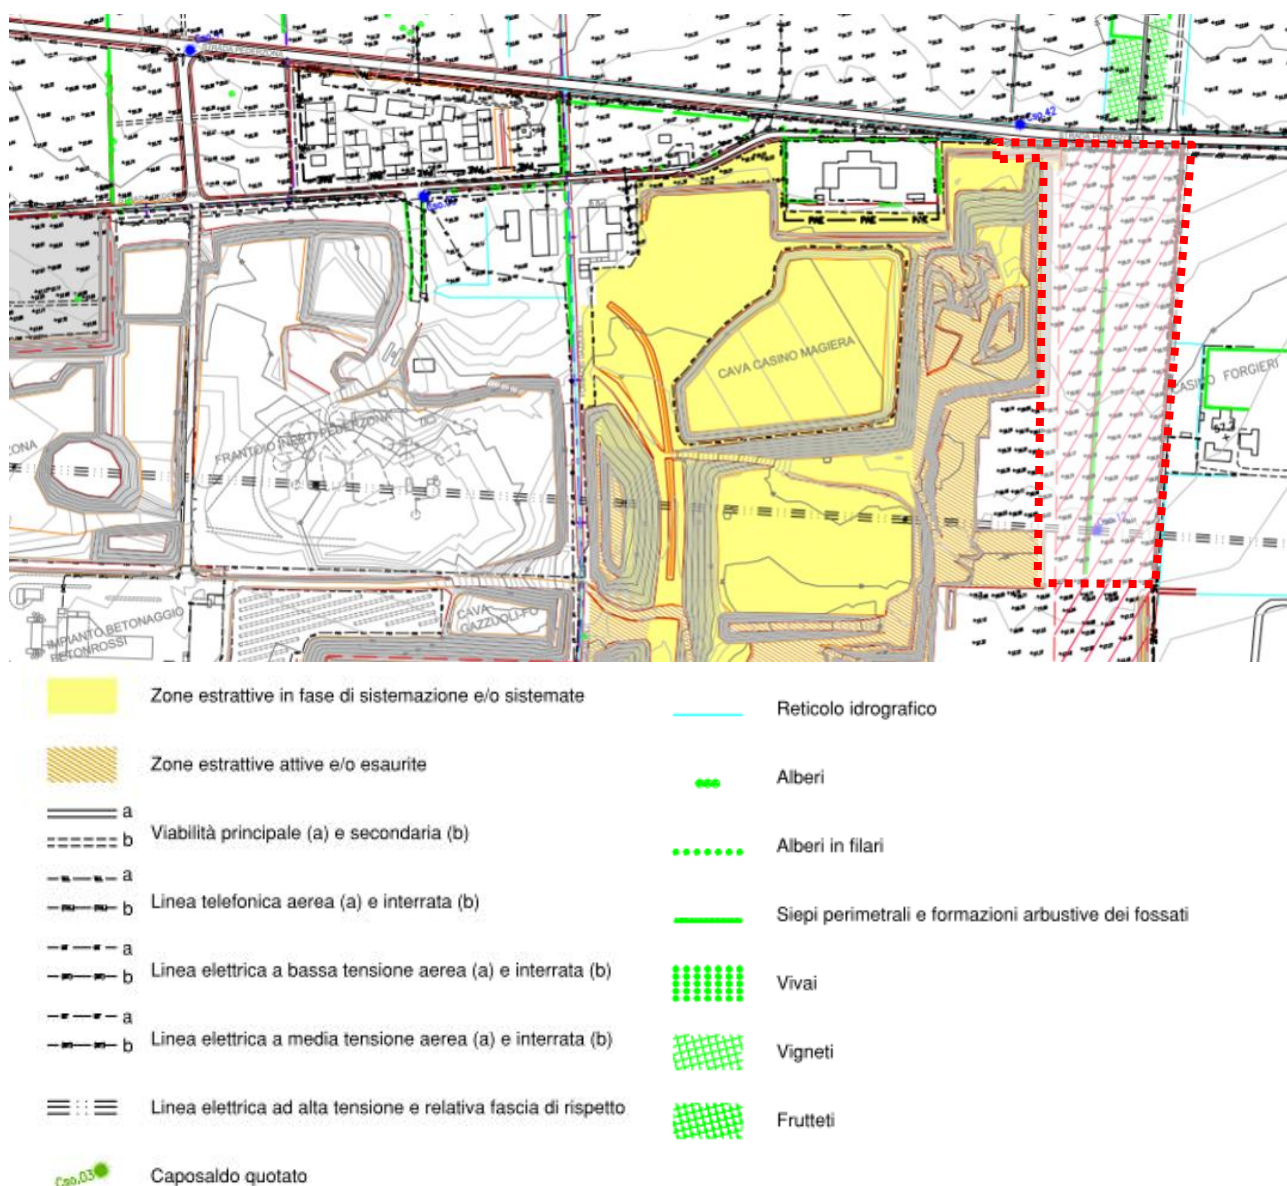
Estratto da tavola 2.2.a del PC "Progetto – Planimetria dello stato di fatto"
